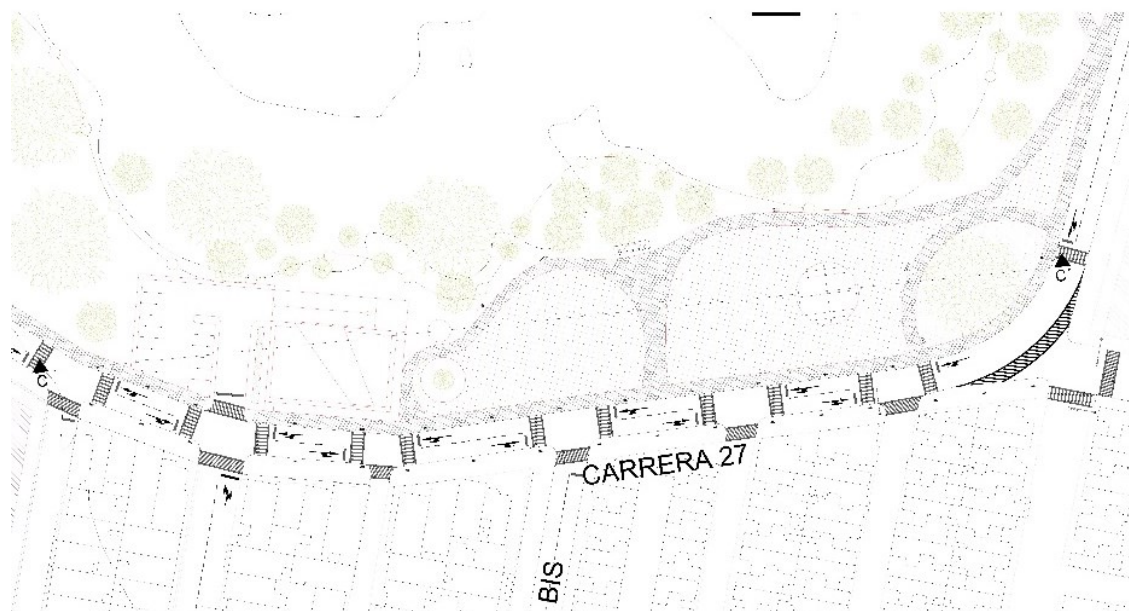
Planos de planta y corte de Mirador Sur Oriental.
